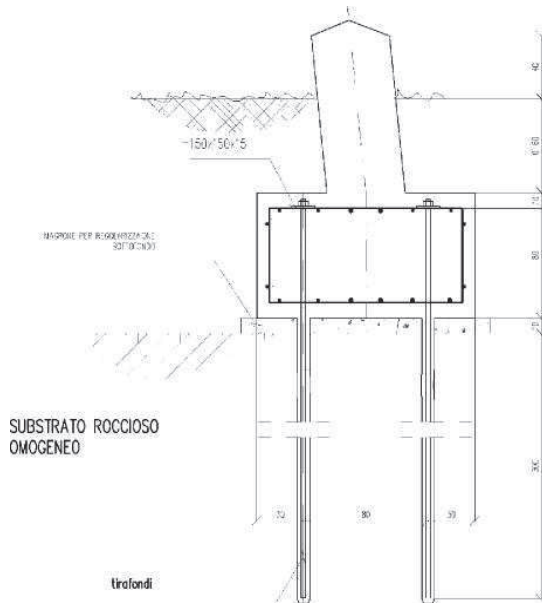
Esempio di fondazione con tiranti in roccia.
